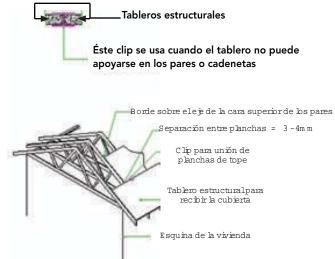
Vista en planta de la disposición de los tableros estructurales en la techumbre.
